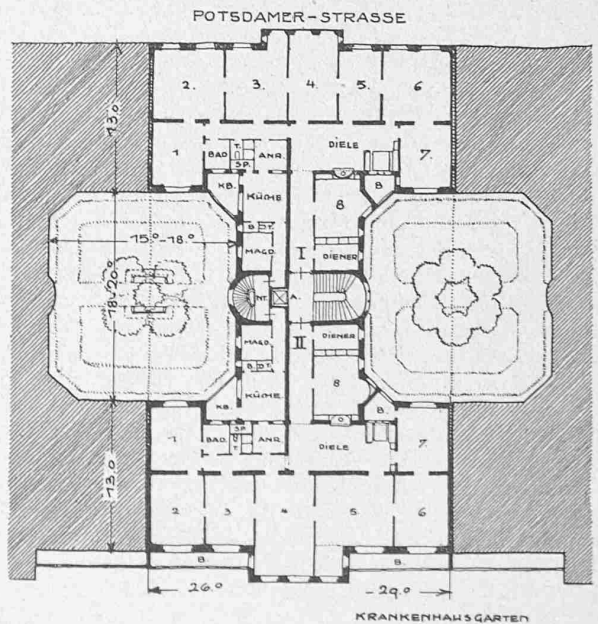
Doppelhaus-Grundriss-Typ (unter Vermeidung des „Berlinerzimmers“). Wohnung I an der Potsdamerstr., Wohnung II am Krankenhausgarten. — 1:600. (Das betreffende Haus ist im Plan Abb. 2 nebenan kreuzweise schraffiert.)
